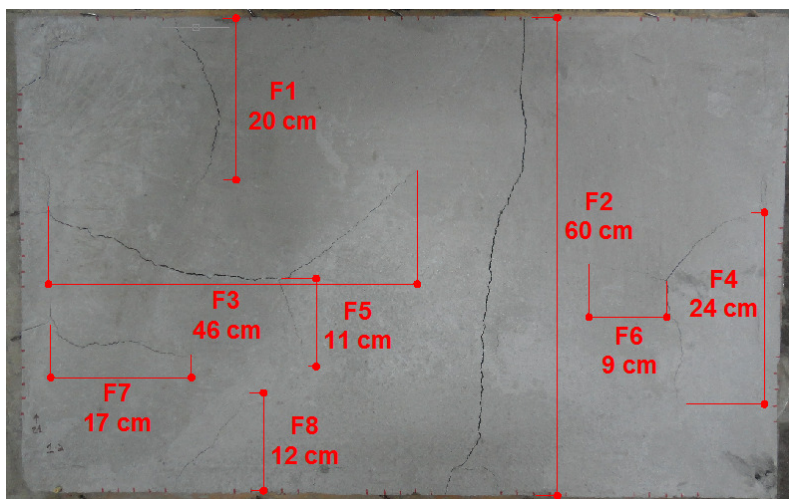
Placa de argamassa fissurada por retração plástica com destaque para os comprimentos visíveis das fissuras
